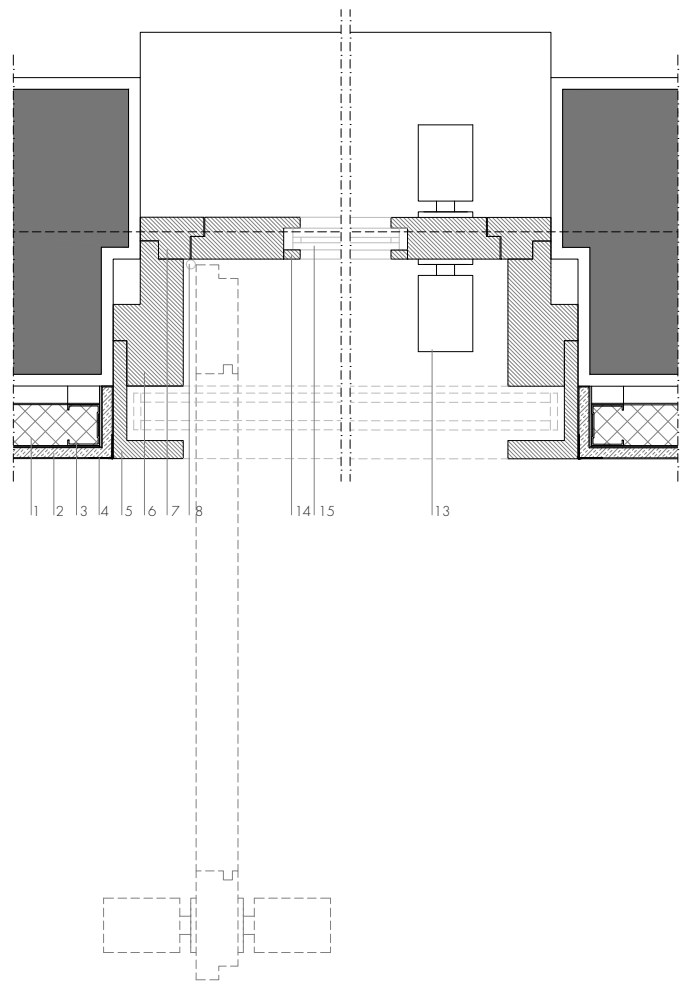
corte horizontal tipo - porta de entrada logradouro
